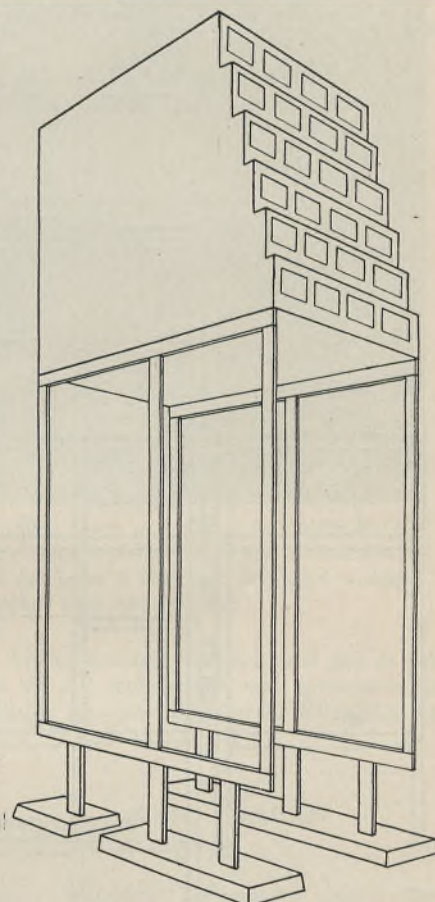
Aufgestockte Geschosse mit eigenen Stützen und eigenem Grundbau.
